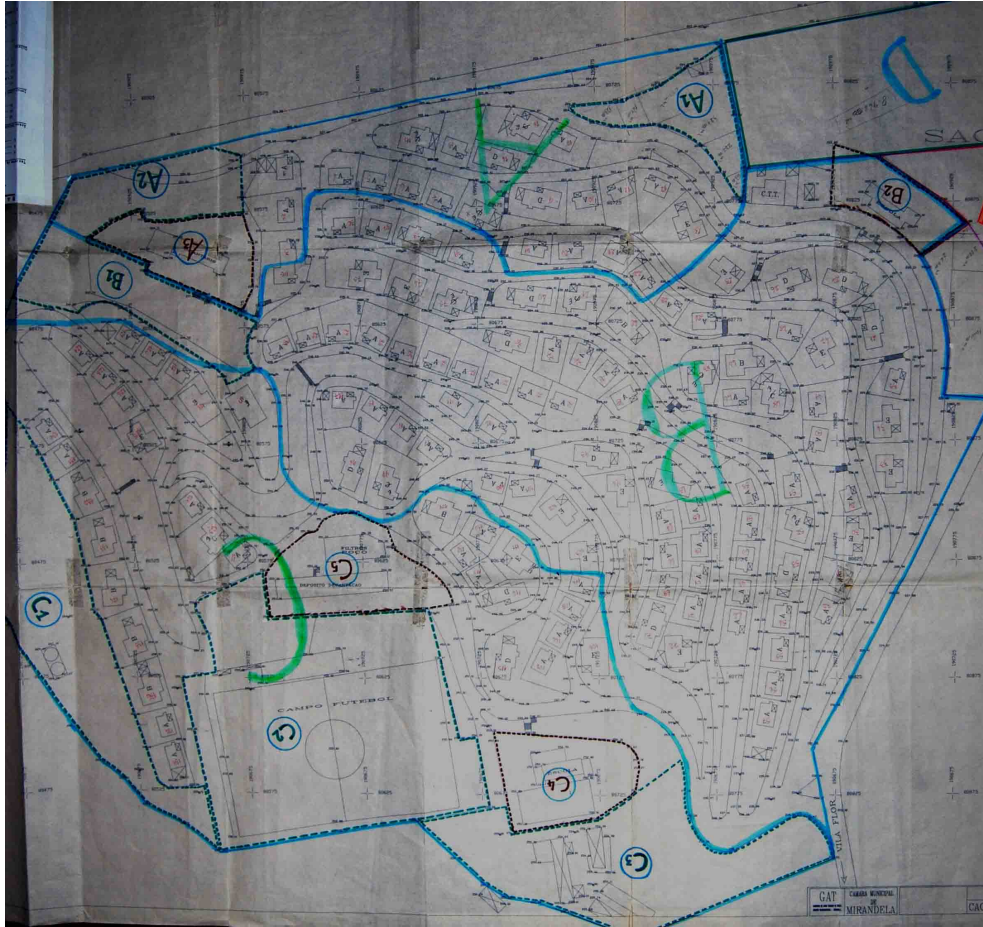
38- Projeto do bairro social- planta geral, (Arquivo AIN).
